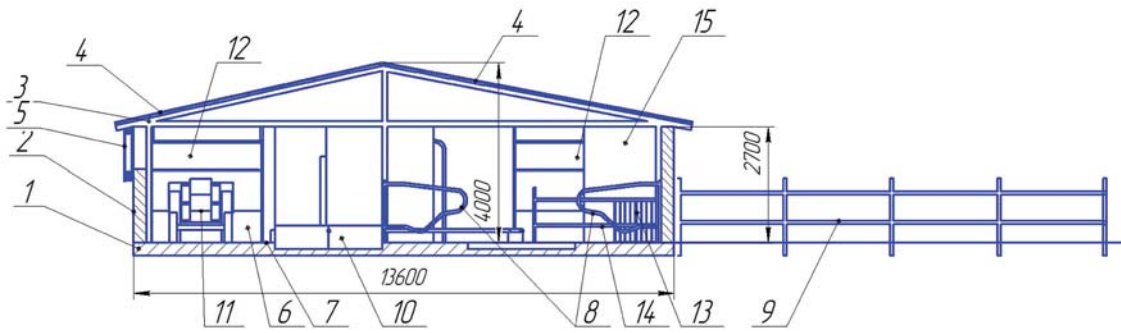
Поперечний переріз будівлі на 50 корів з поголів'ям молодняку: 1 – підлога бетонна; 2 – стіни з шлакоблоків; 3 – каркас з металоконструкцій; 4 – покрівля даху з профнастилу; 5 – штора вентиляційна; 6 – галерея; 7 – кормовий стіл; 8 – огороження боксів для відпочинку корів; 9 – огороження вигульних майданчиків; 10 – скреперна гноєприбиральна установка; 11 – малогабаритний фермський комбайн; 12 – ворота ролети; 13 – клітки для телят профілакторного періоду; 14 – денник; 15 – агрегатна
